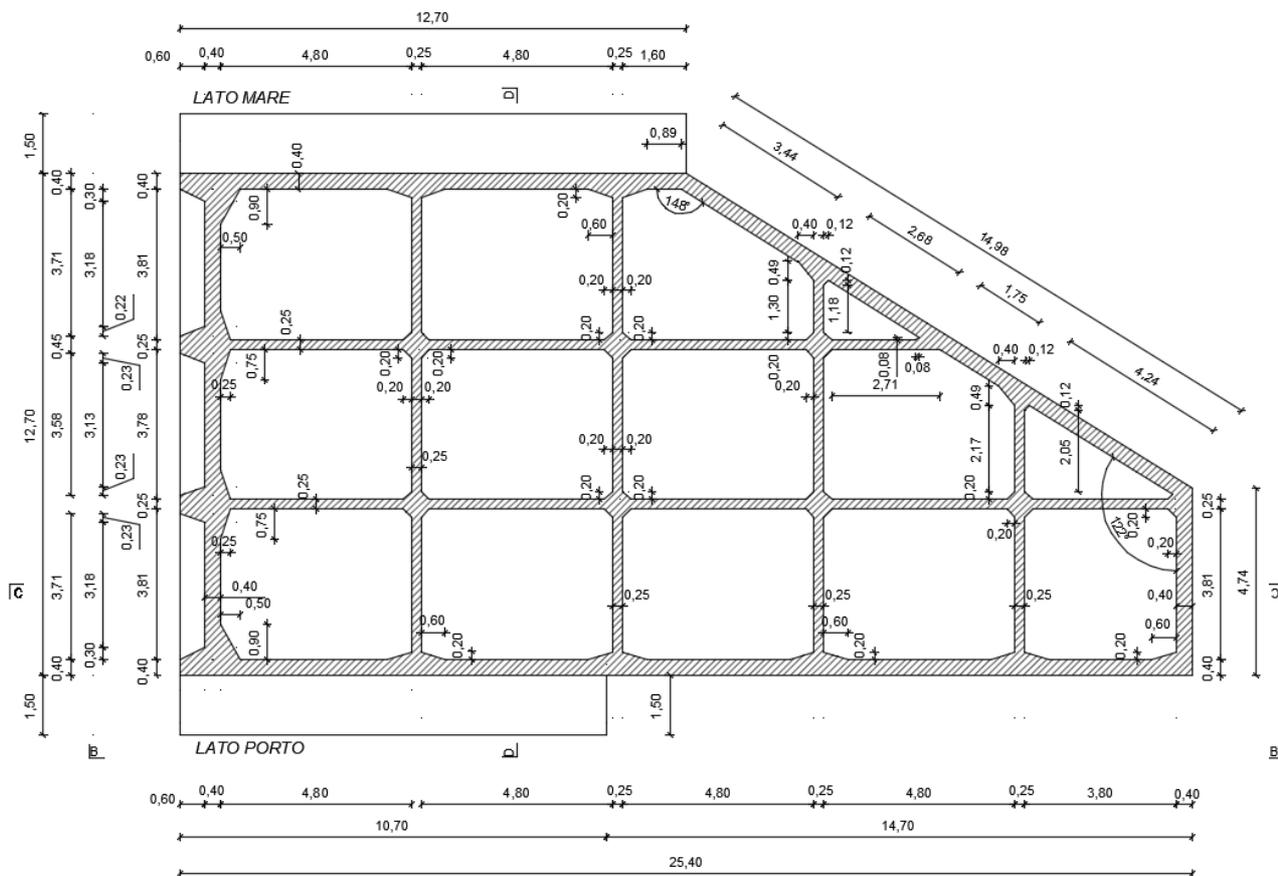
Cassoni tipo 2 (trapezio): Carpenteria - Pianta (Sezione orizzontale A-A)
